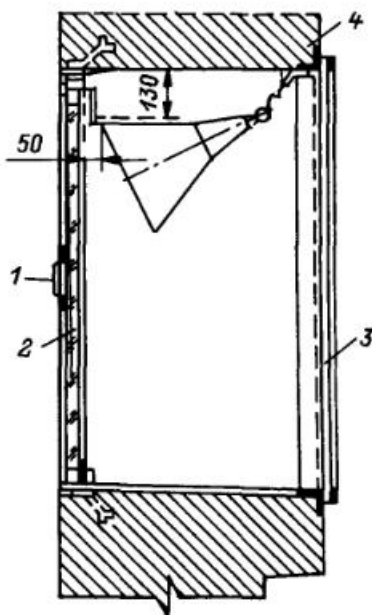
Освещение помещения светильником, установленным в стенной нише
